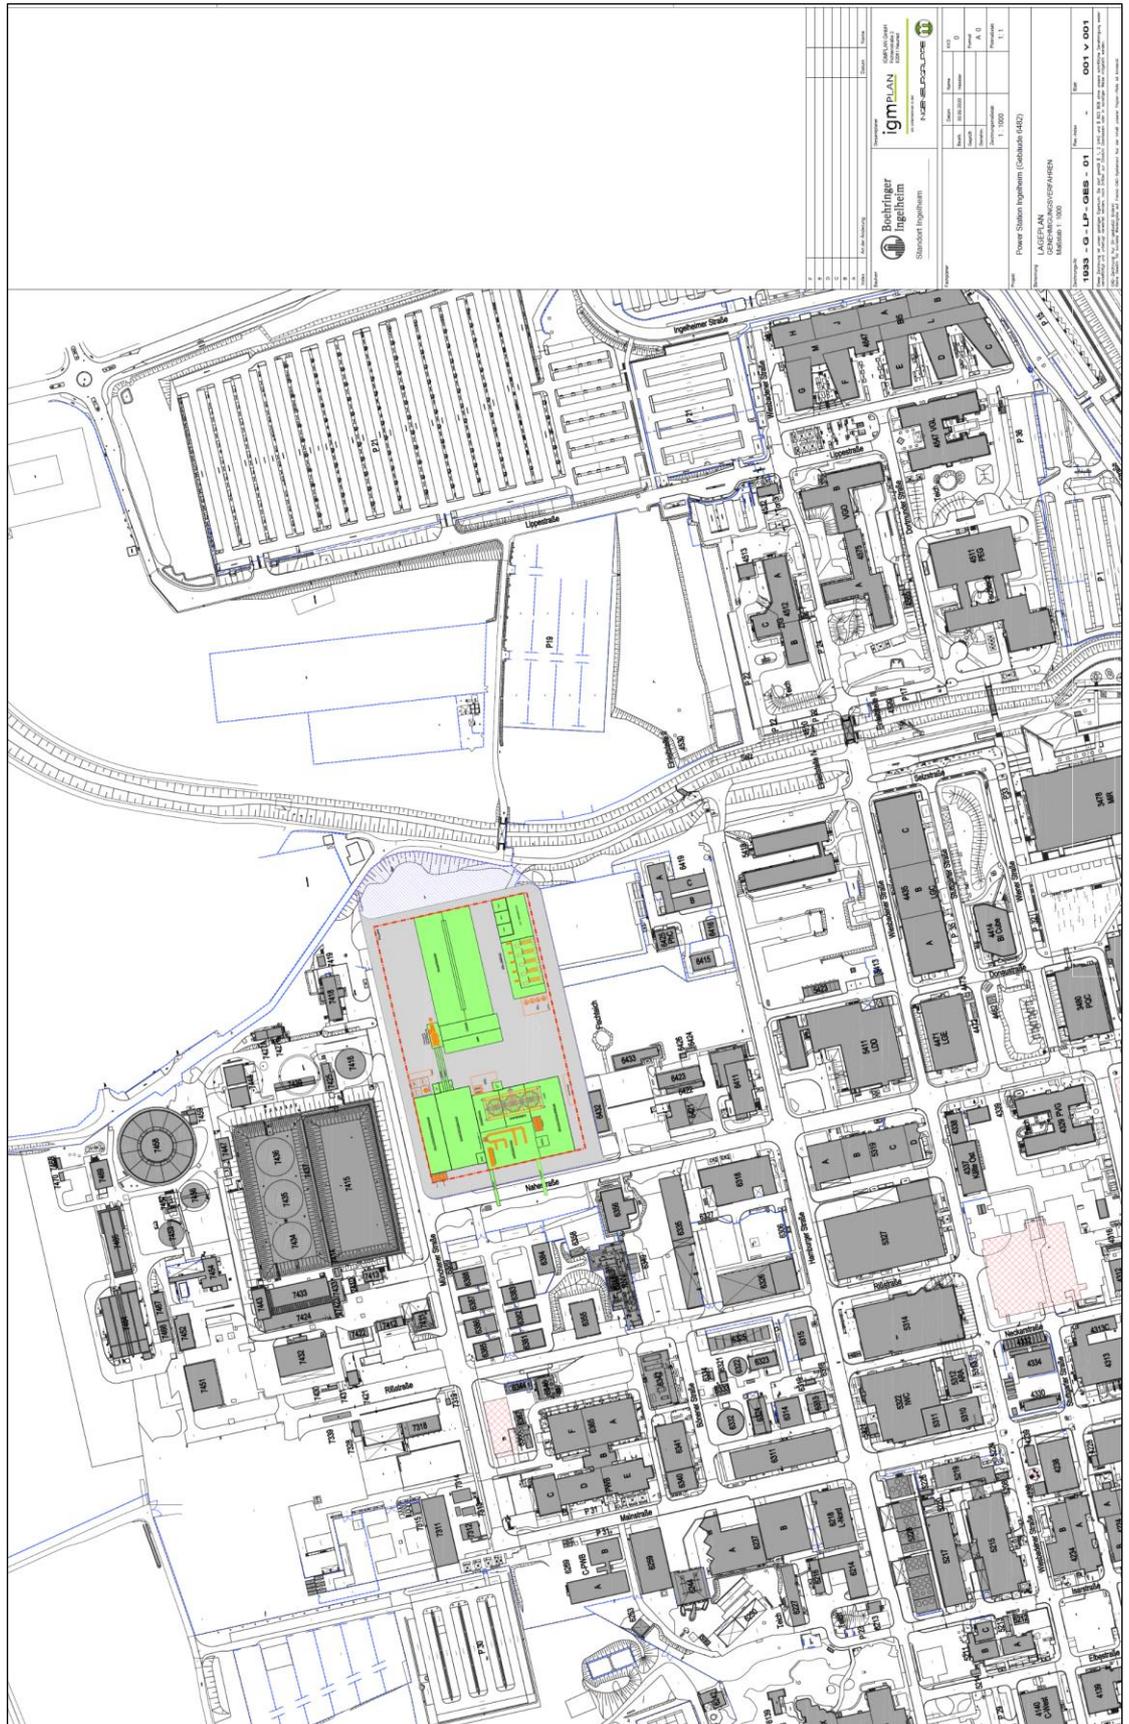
Lageplan des Vorhabenstandortes (M 1:1.000)
